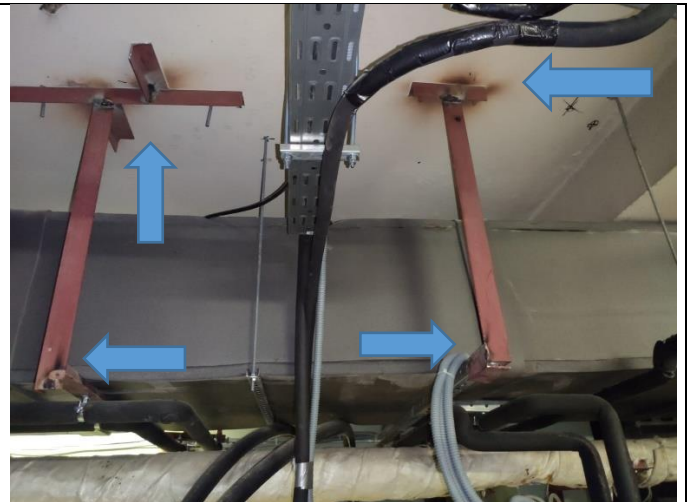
Сварные соединения не покрыты антикоррозионным покрытием
